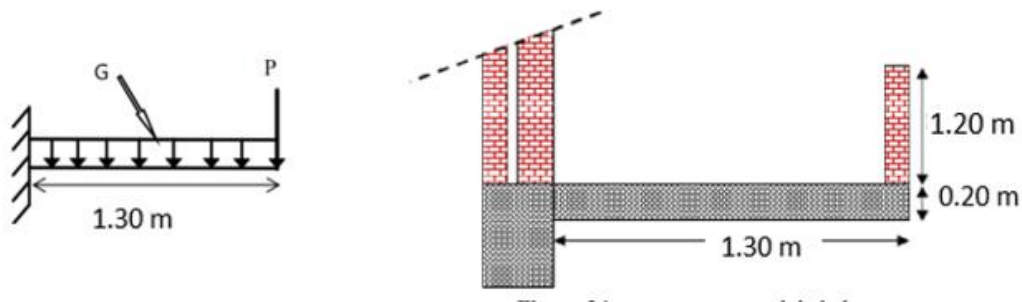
Schéma statique et coupe transversal du balcon.
